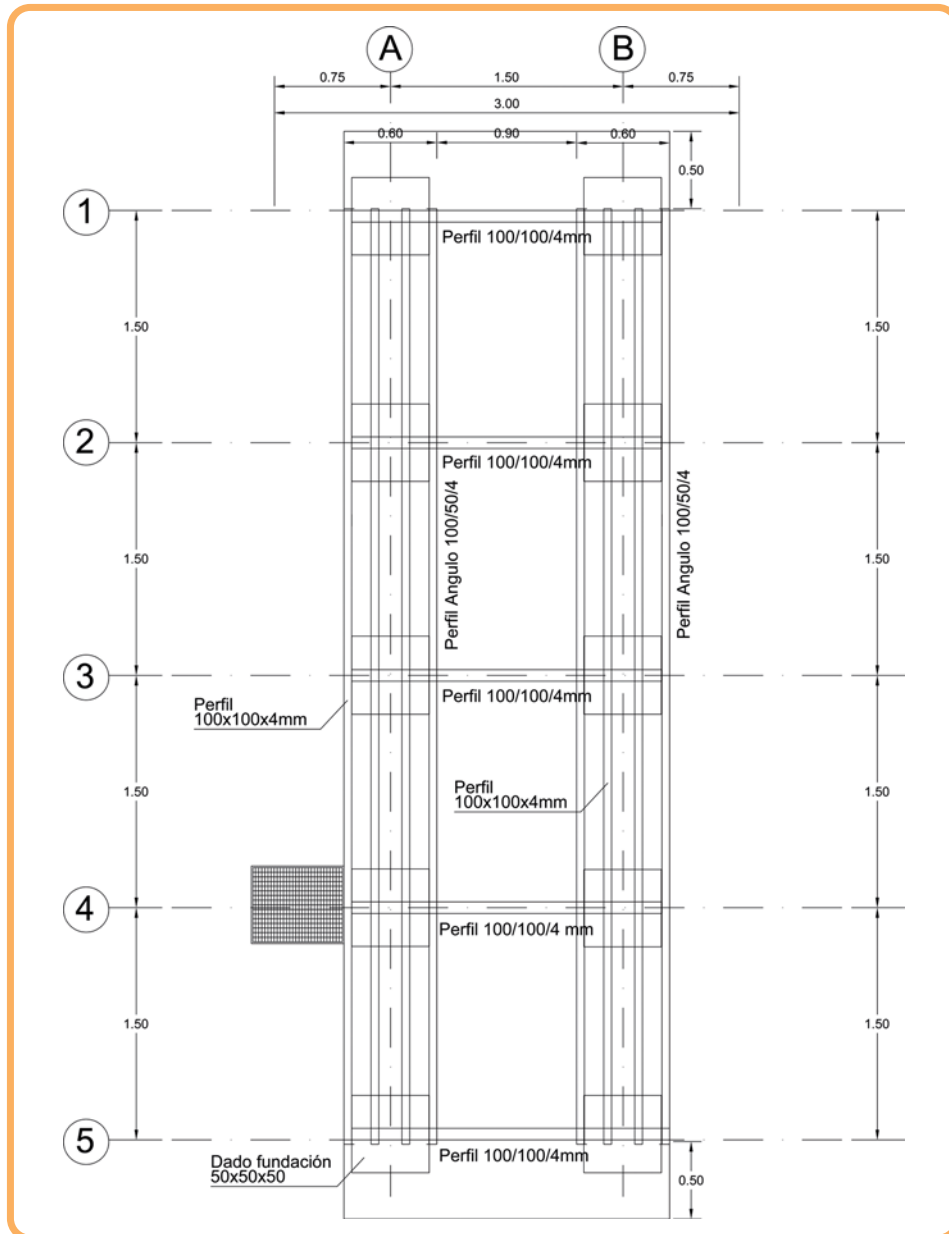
b) Vista de planta con la rampa de estacionamiento y perfiles (1 - 5)
